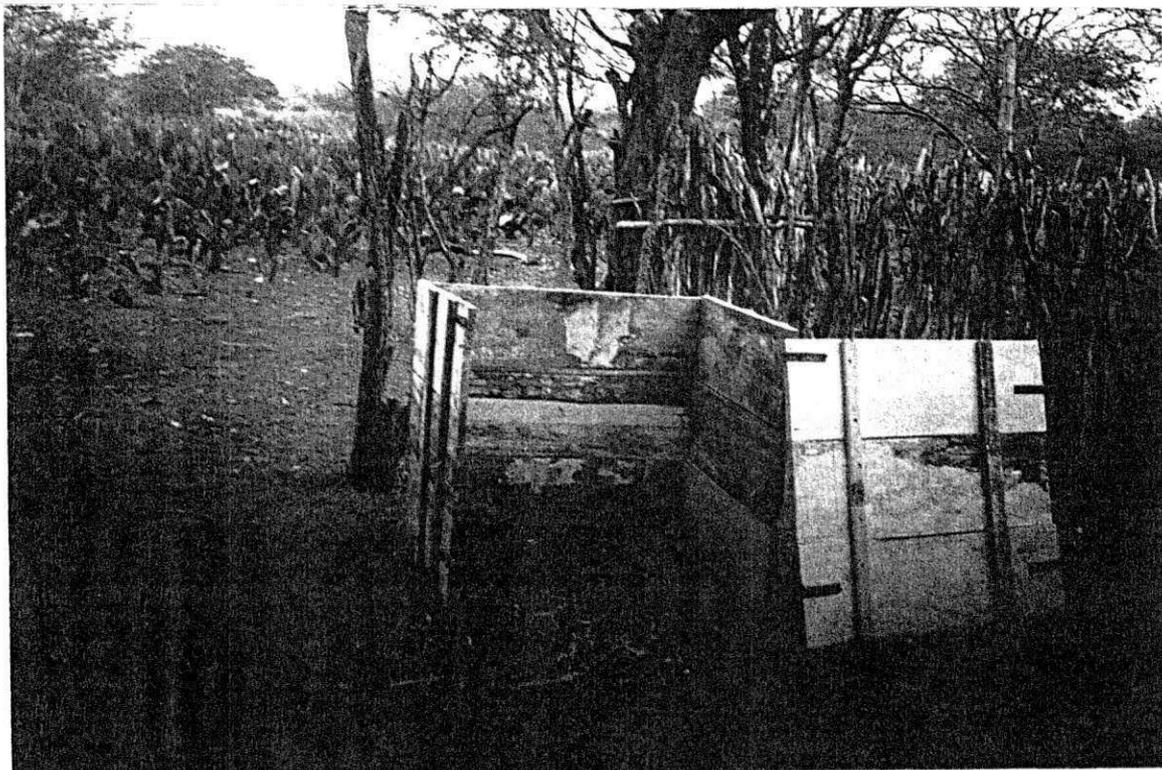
Fôrma para fabricação do tijolo da silagem .
